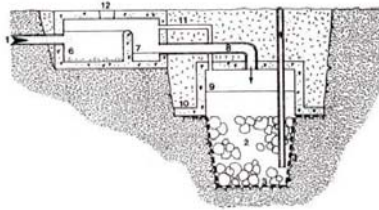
Pozo de infiltración con decantador y volumen parcial sin relleno. 6.- Decantador, 7.- Cámara rebase, 8.- Tubería alimentación, 9.- Volumen sin relleno, 10.- Antepozo de hormigón armado, 11.- Tubo ventilación, 12.- Tapa cámara. 1 a 5 como en a.
